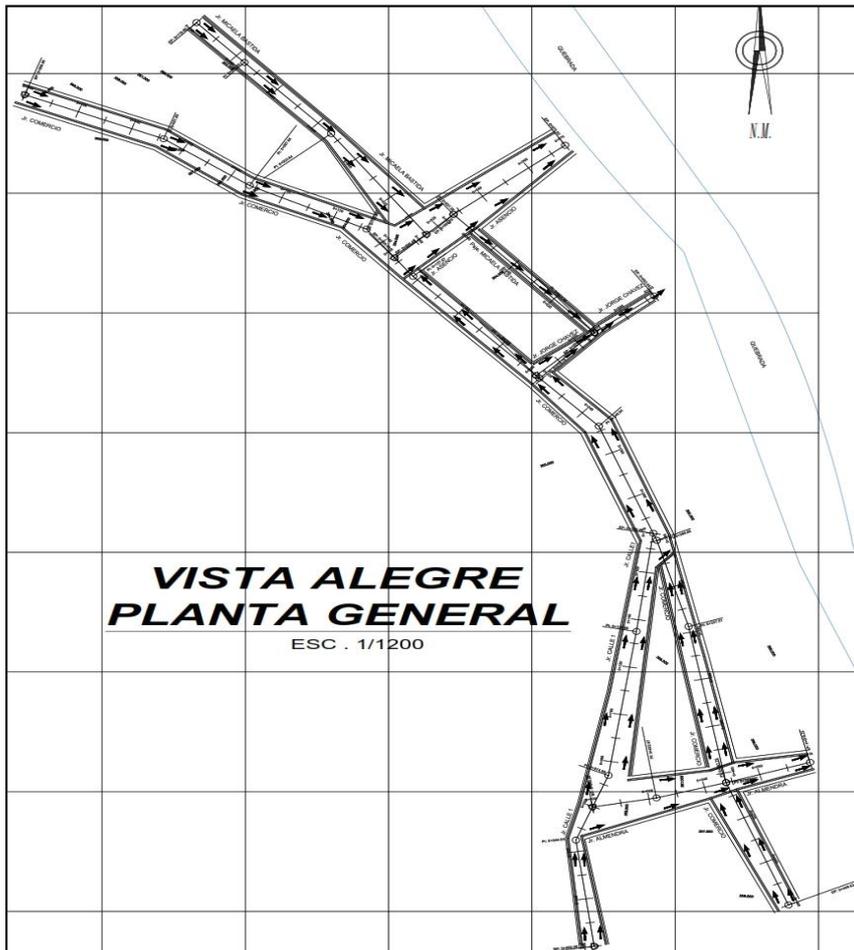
Plano del diseño de la red de alcantarillado pluvial.
